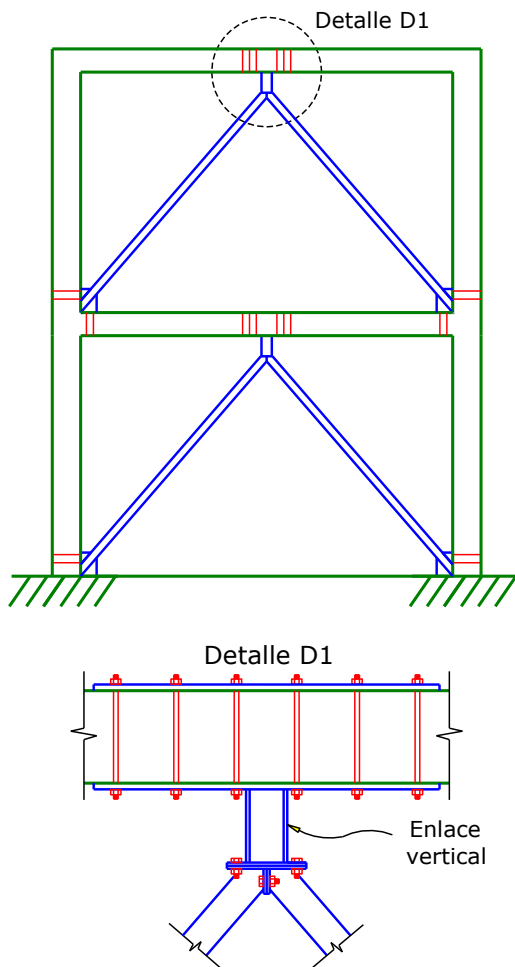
Riostras de acero con enlace vertical para la rehabilitación de un pórtico de hormigón armado.
